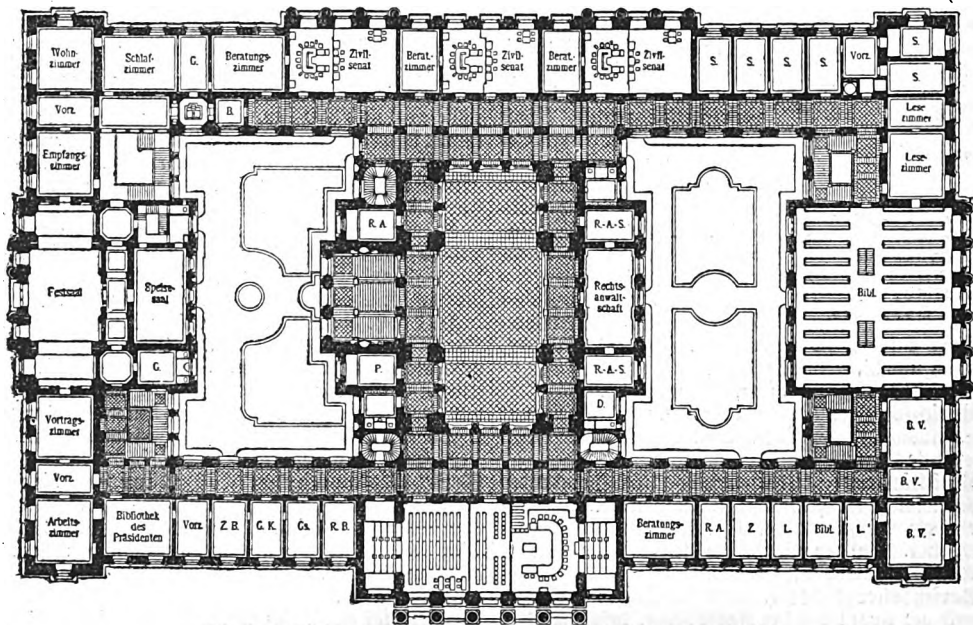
Reichsgerichtsgebäude. Grundriß des obern Hauptgeschosses.
